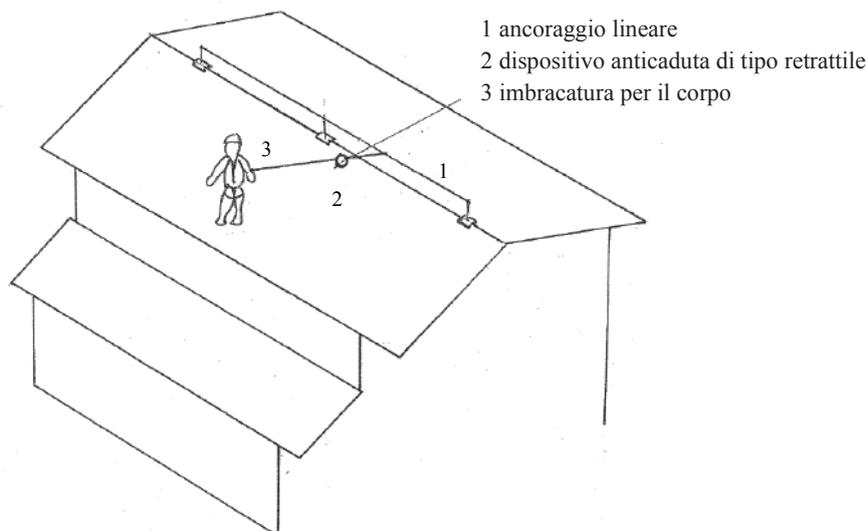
Esempio di sistema di arresto caduta con dispositivo anticaduta di tipo retrattile su ancoraggio lineare
